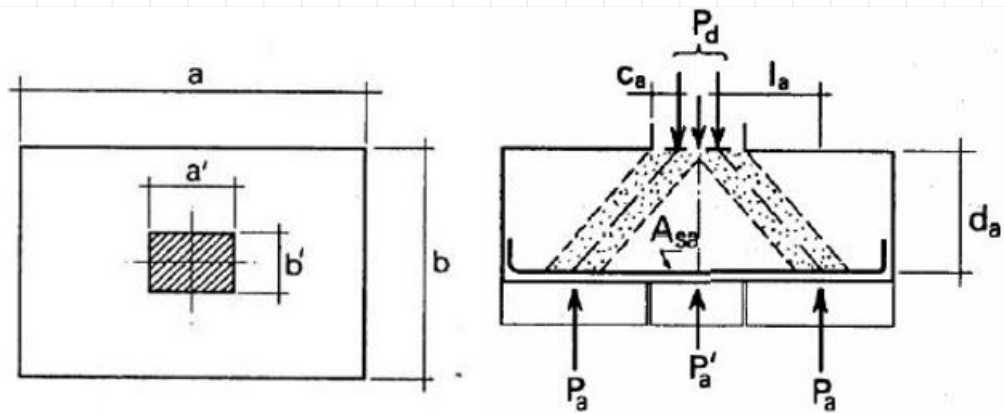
schematizzazione della distribuzione delle forze sulla base della fondazione a plinto
